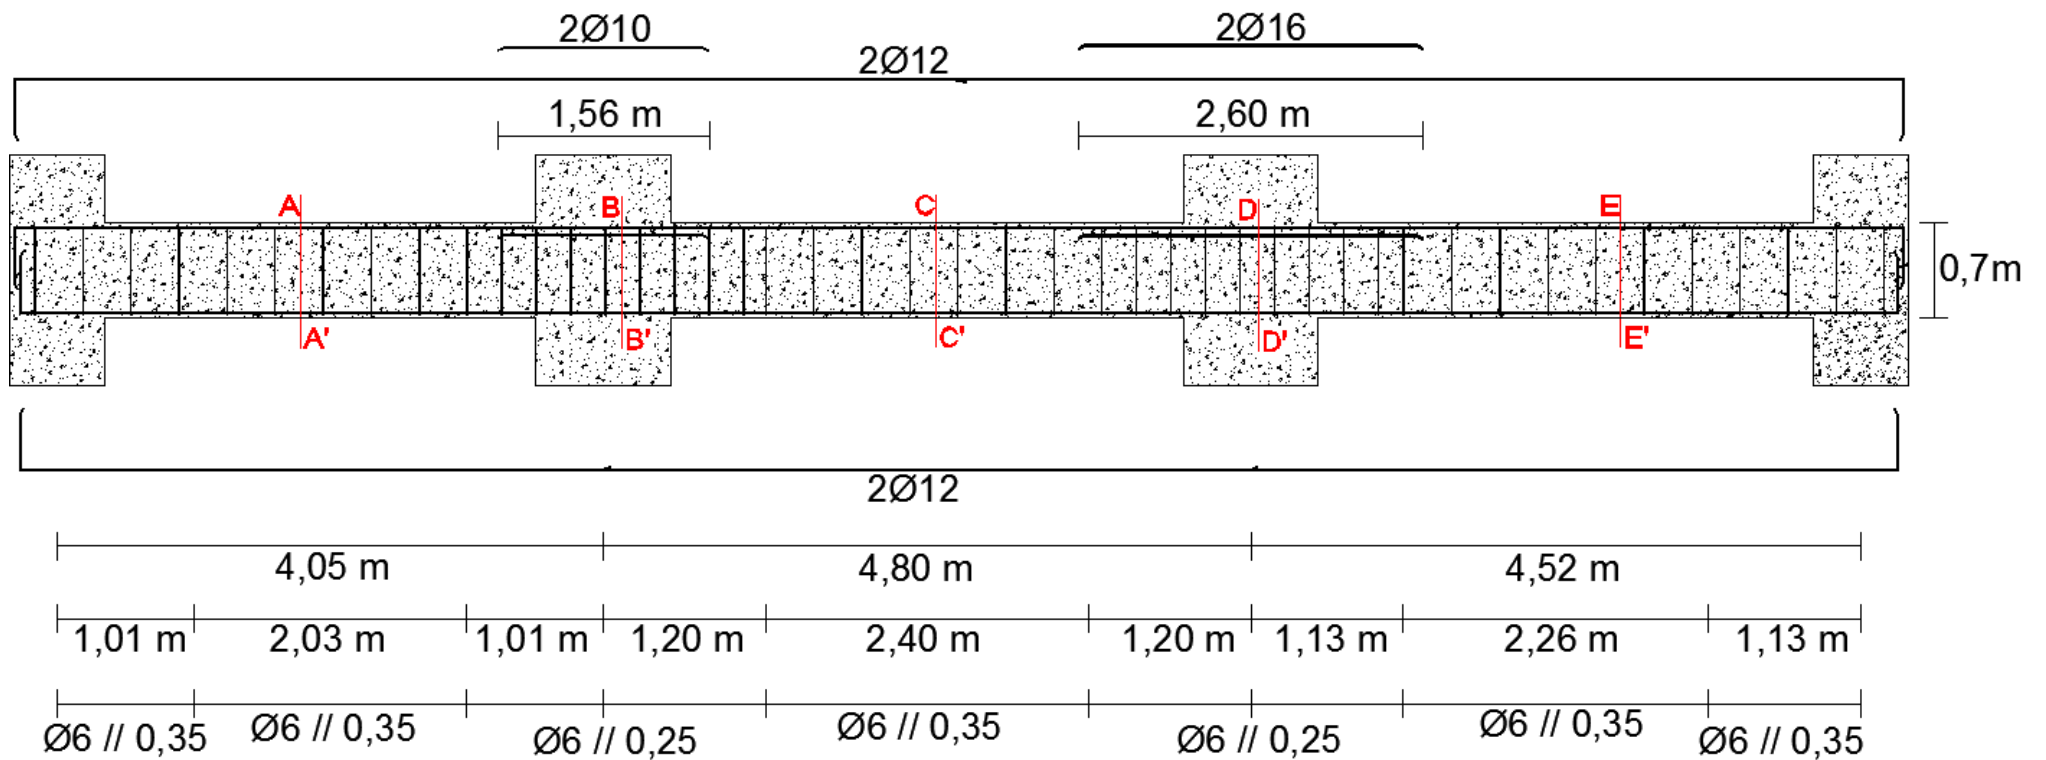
Corte longitudinal viga Pórtico 1-1' - piso 1
